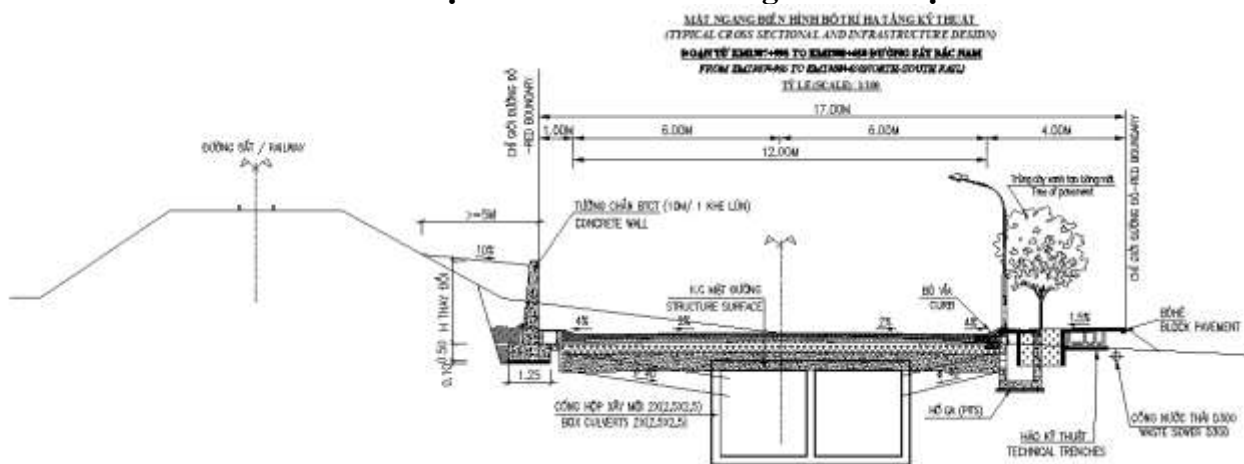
Mặt cắt điển hình đường Chử Đồng Tử
